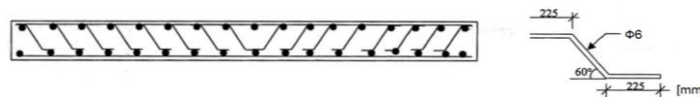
Armadura de esforço transverso em corte longitudinal. Adaptado de [23]
